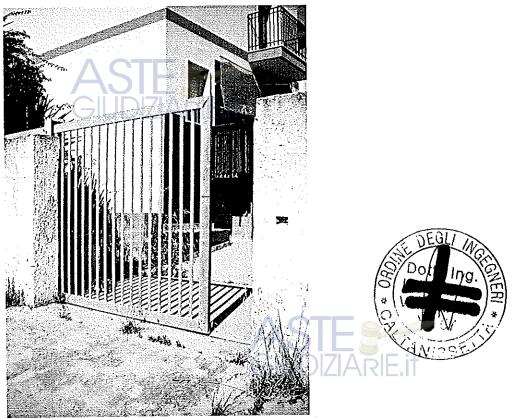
Vista del cancello di ingresso metallico non meccanizzato.
